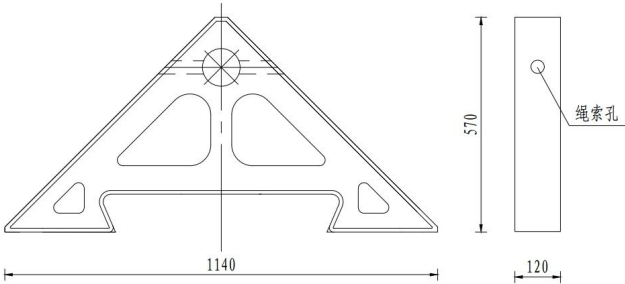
三角形生态砌块 B 平面及侧面图
